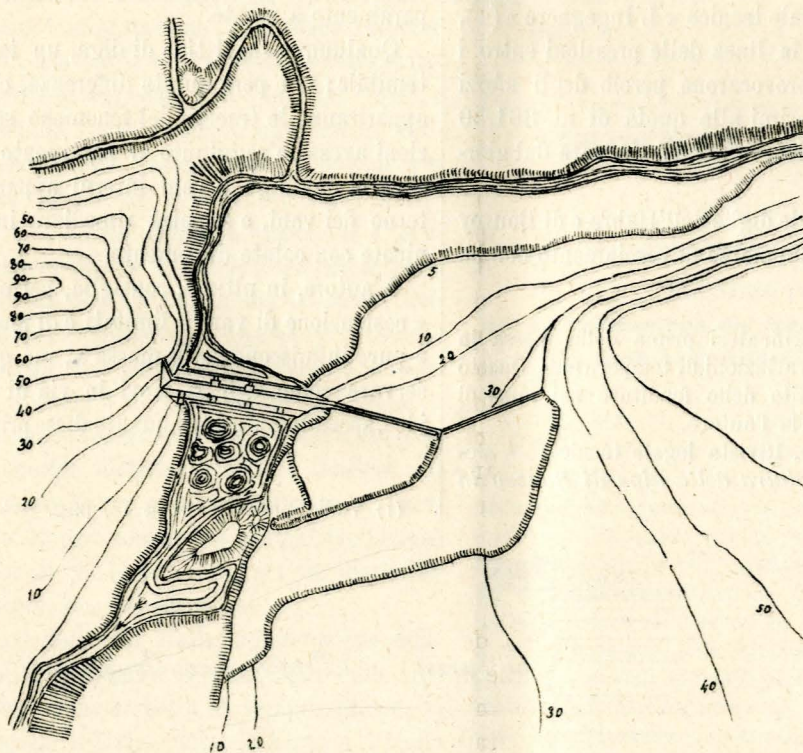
Diga sul fiume Habra. — Planimetria (Scala di 1:8000).
